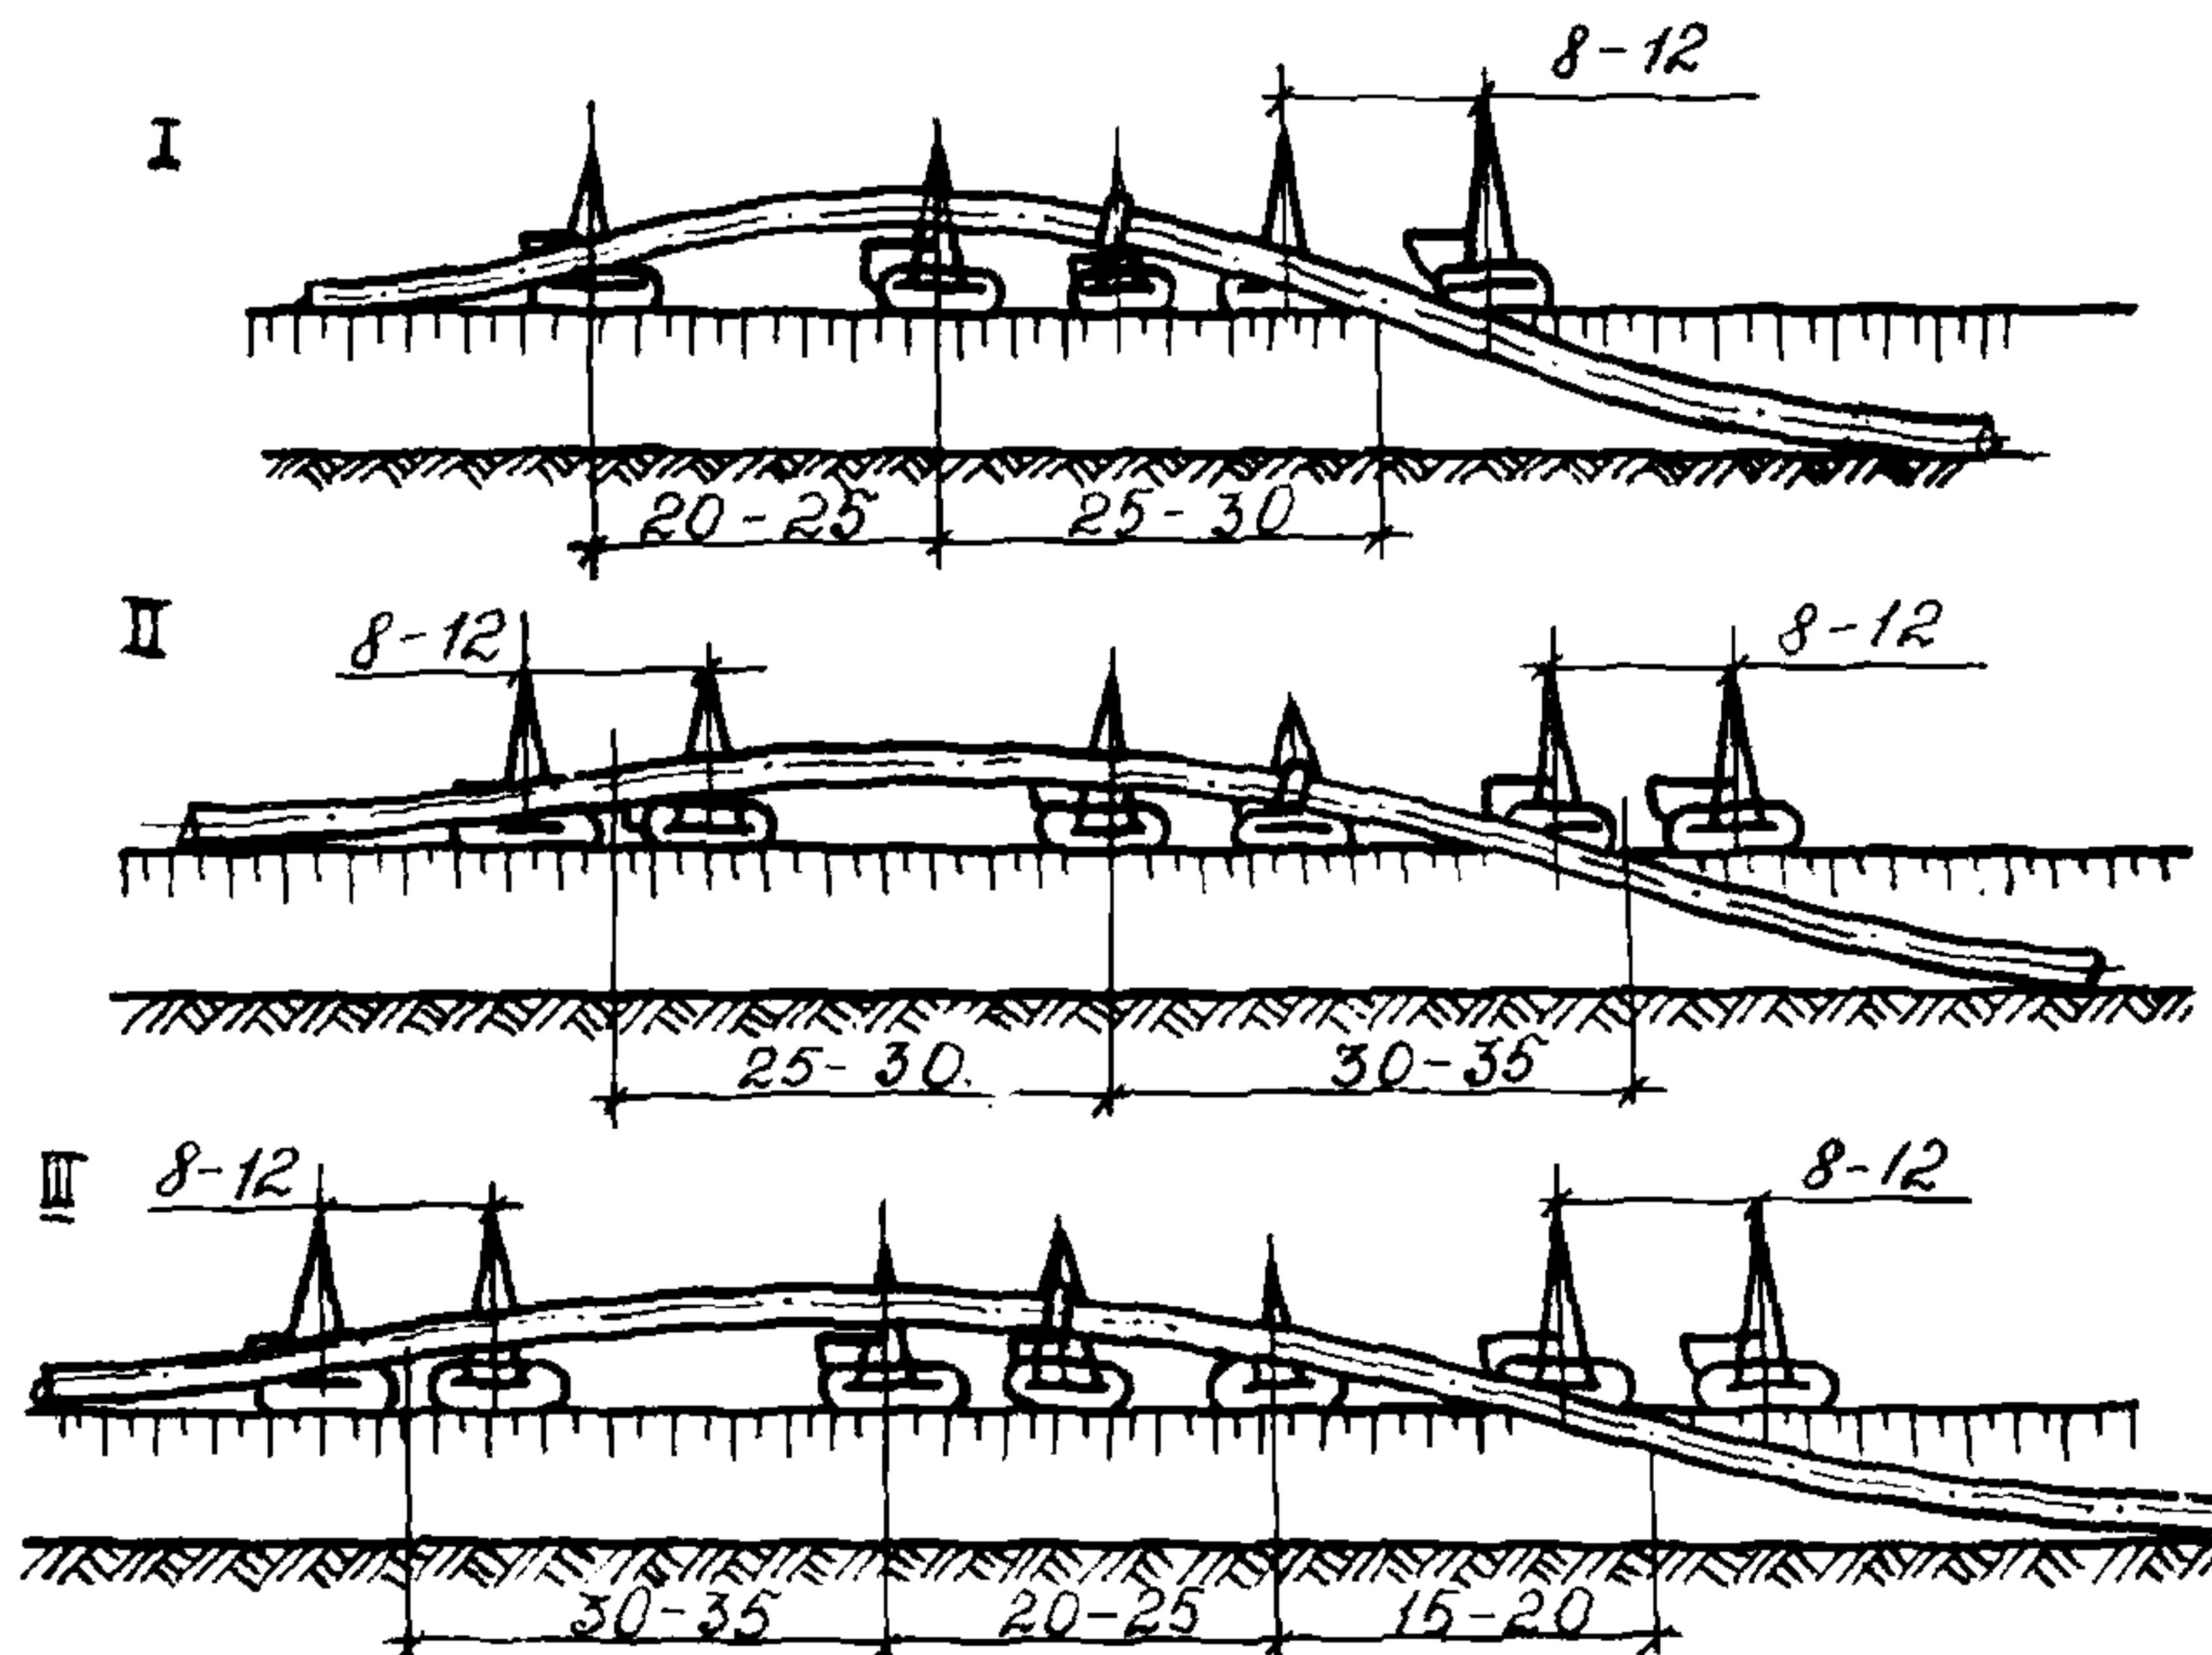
Схемы укладки трубопровода в траншее с применением машин типа МС: I, II, III - схемы для трубопроводов соответственно диаметрами 1020, 1220 и 1420 мм
